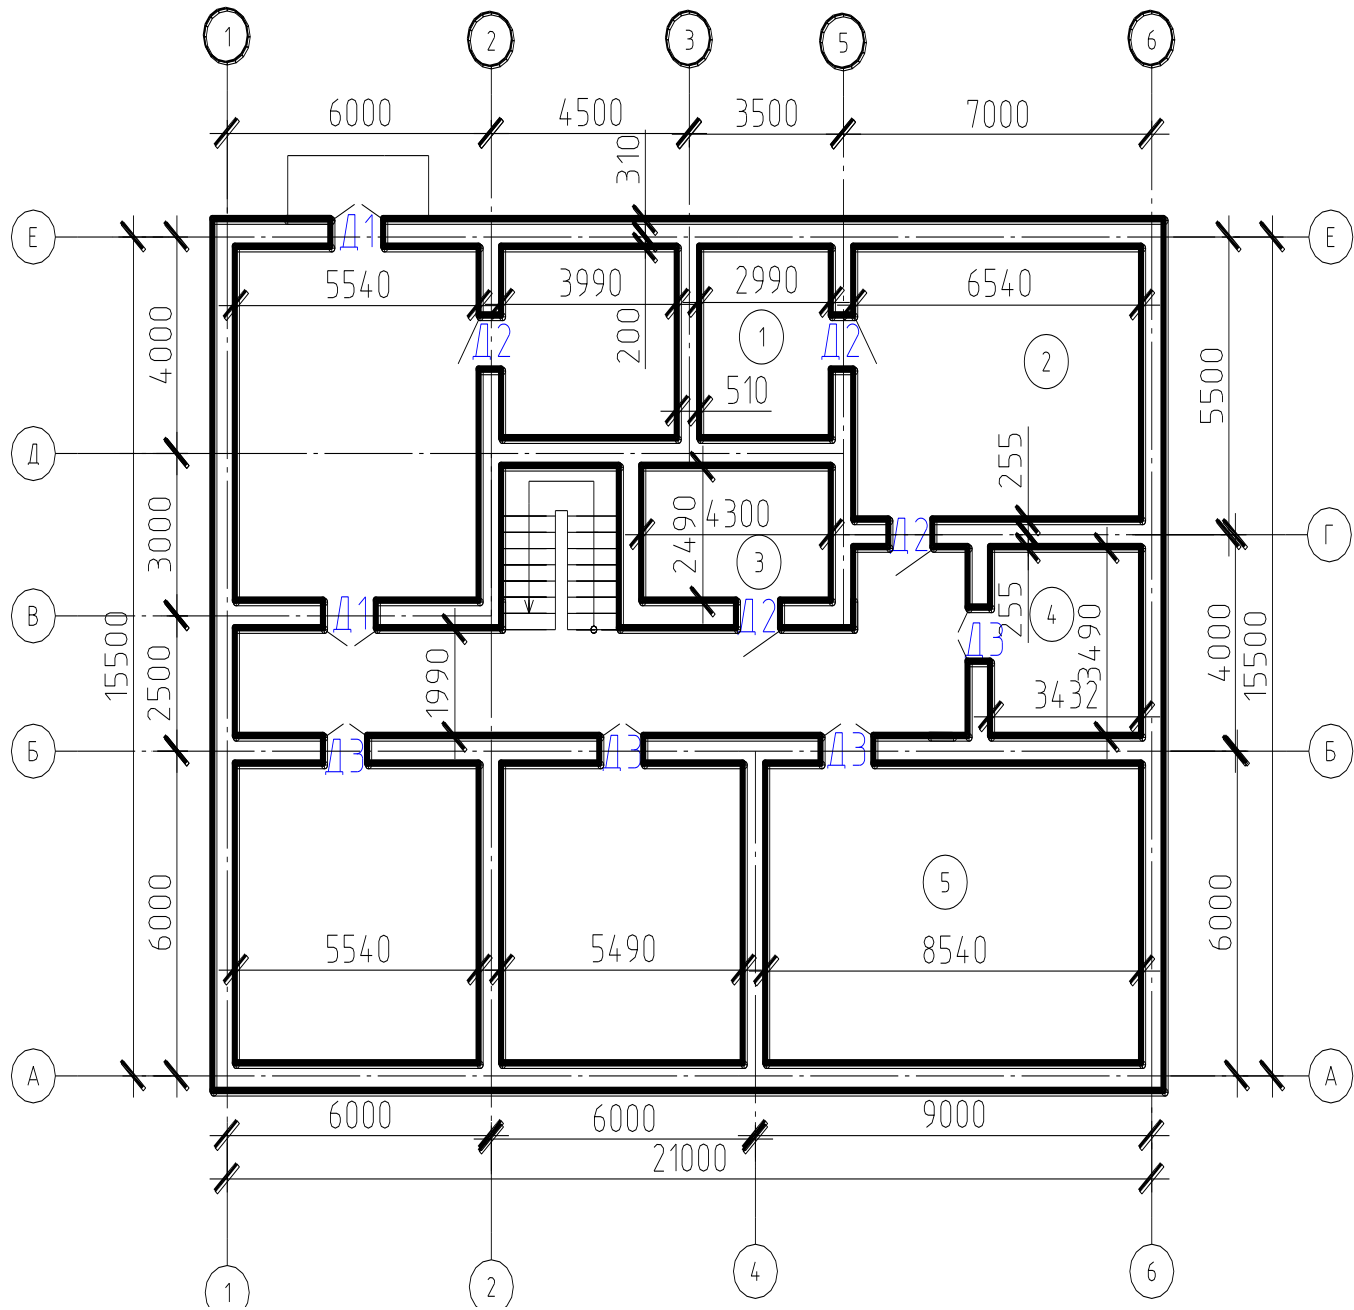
Высшее учебное заведение. План 1-го этажа
